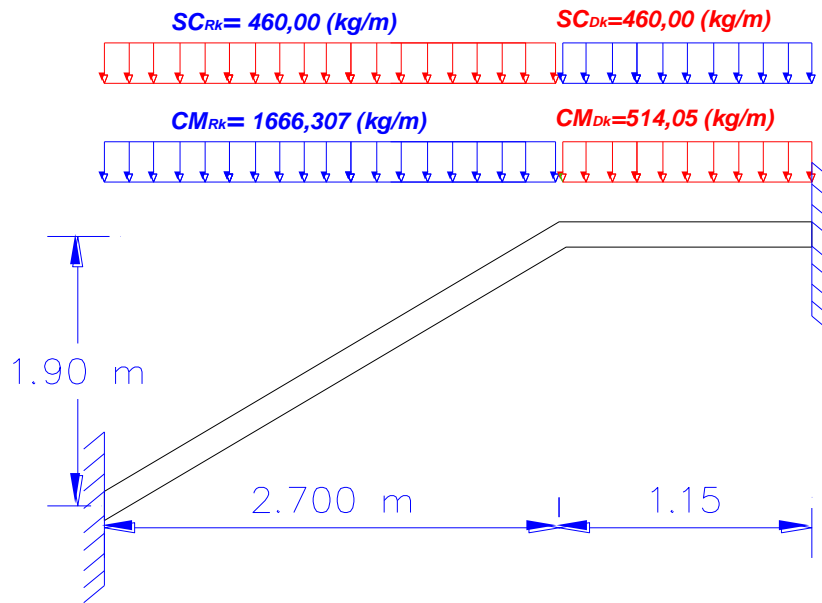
Consideración de la escalera para el cálculo de la armadura negativa.
